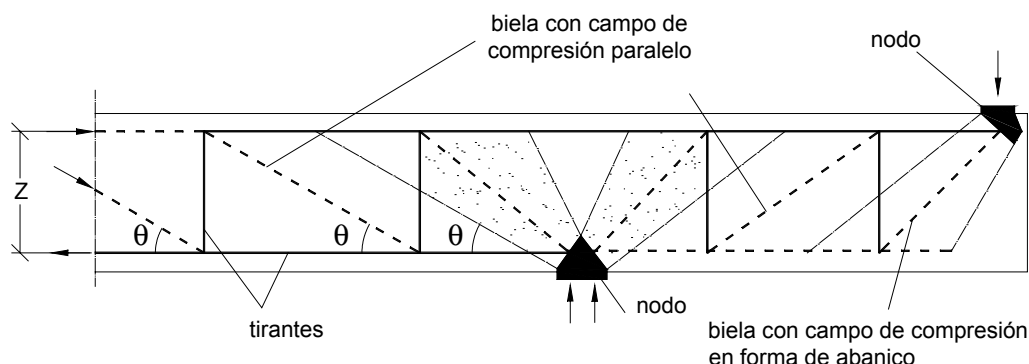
Modelo reticulado y campos de tensión para una viga con voladizo
